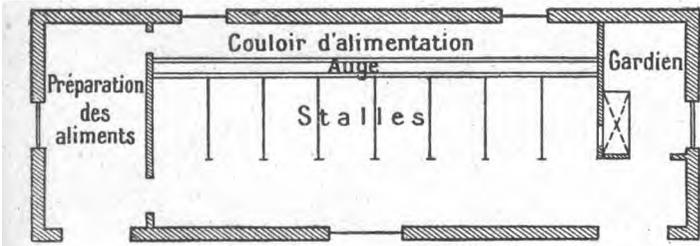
Plan d'une étable longitudinale à couloir d'alimentation (type moderne).
